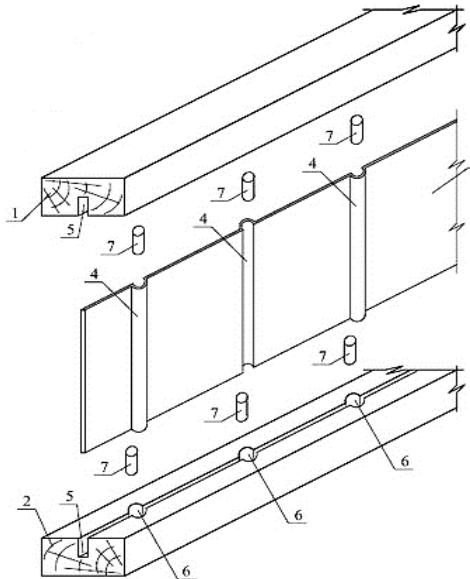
Металлодеревянная балка со стальной стенкой
